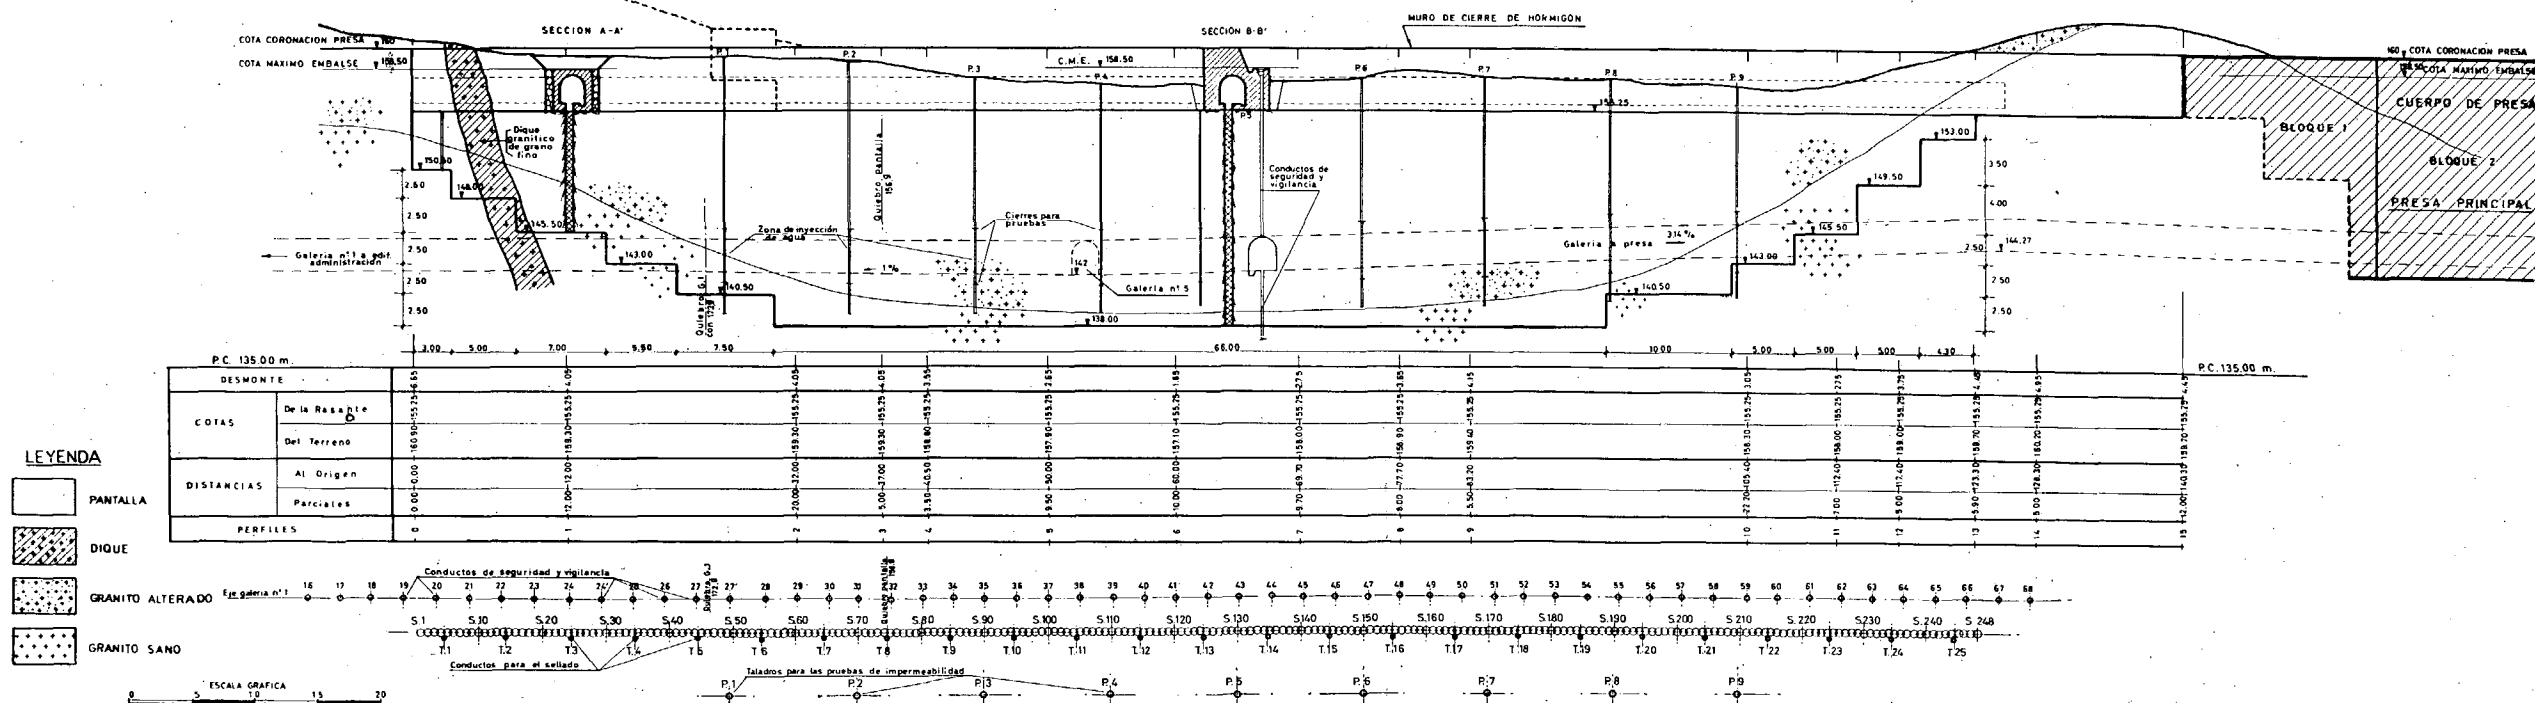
a — Sistema de impermeabilización del collado "Dels Fangots", en el pantano de Boadella.
